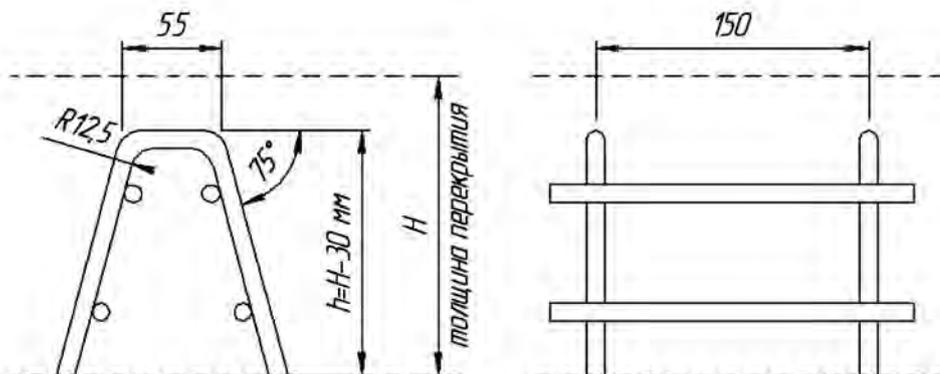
Подставка-фиксатор (1-й вариант) для установки в проектное положение верхних сеток перекрытий здания
